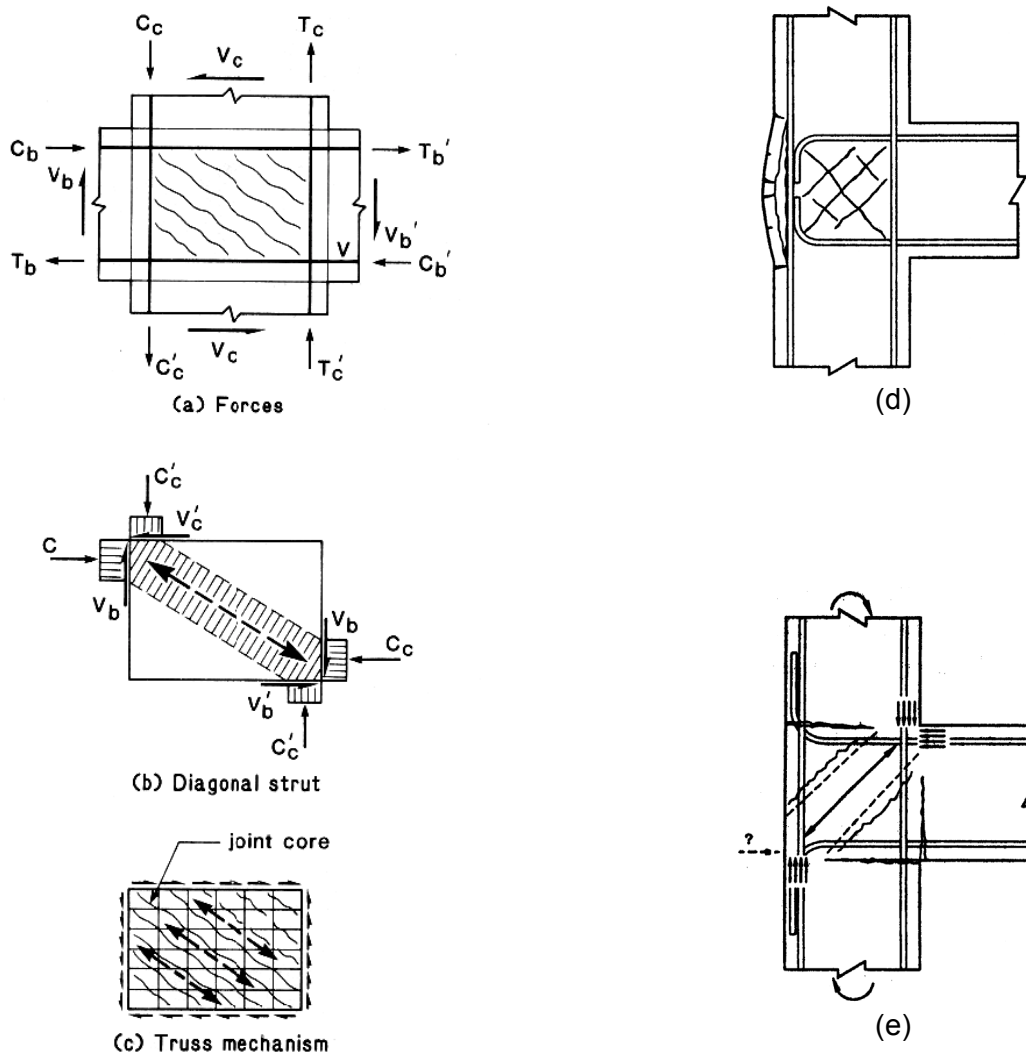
Starea de eforturi și mecanismele de preluare a forței tăietoare într-un nod (a, b, c) - Derecho și Kianoush, 2001; detalierea armăturilor longitudinale din riglă pentru asigurarea mecanismului de diagonală comprimată (d, e) - Priestley, 1997.
